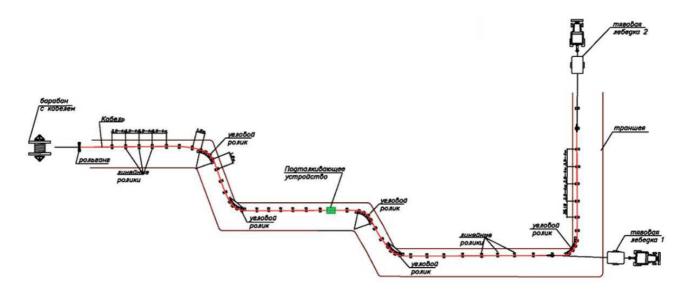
вариант монтажа кабеля двумя лебедками и кабельным толкателем
